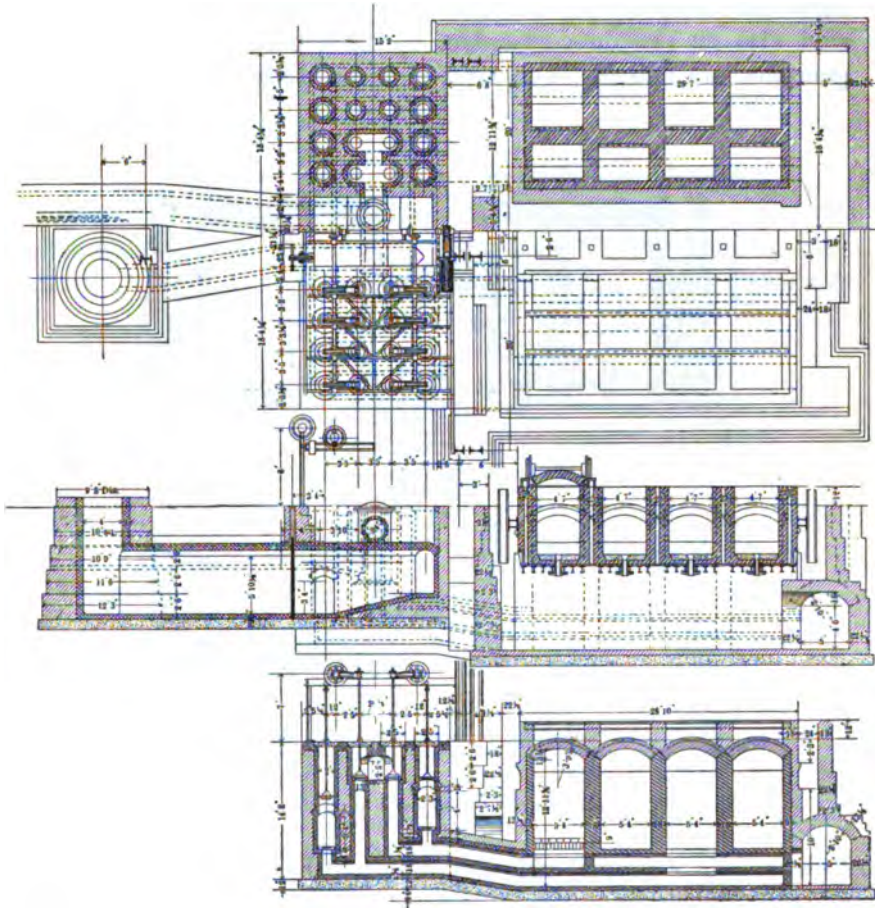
Grundriß und Schnitt durch die Tieföfen.
